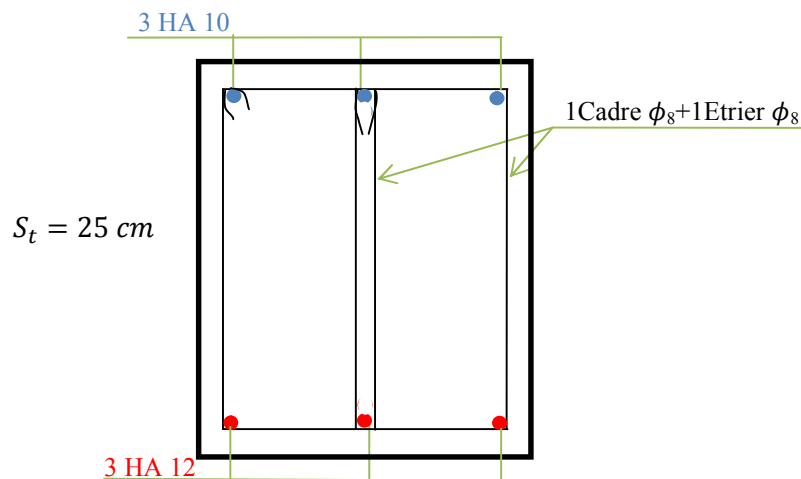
Schéma de ferrailage de la poutre de chaînage
